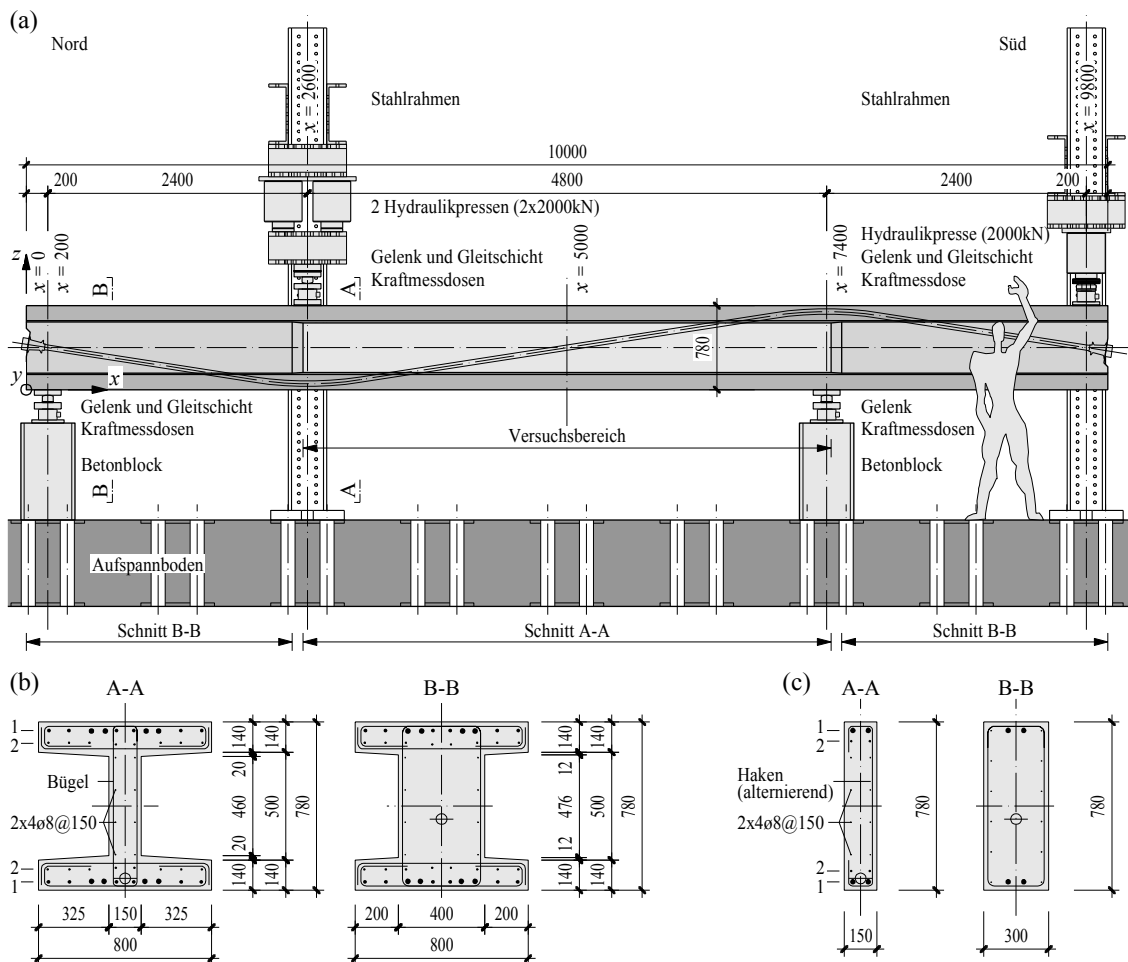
Versuchsaufbau, Trägerabmessungen und Bewehrung (Masse in [mm], Querkraftbewehrung und Bewehrung Layer 1 und 2 in Tabelle 3.1): (a) Längsansicht des Versuchsaufbaus; (b) Abmessungen und Bewehrung der Träger mit Flanschen; und (c) Abmessungen und Bewehrung der Träger ohne Flansche.
